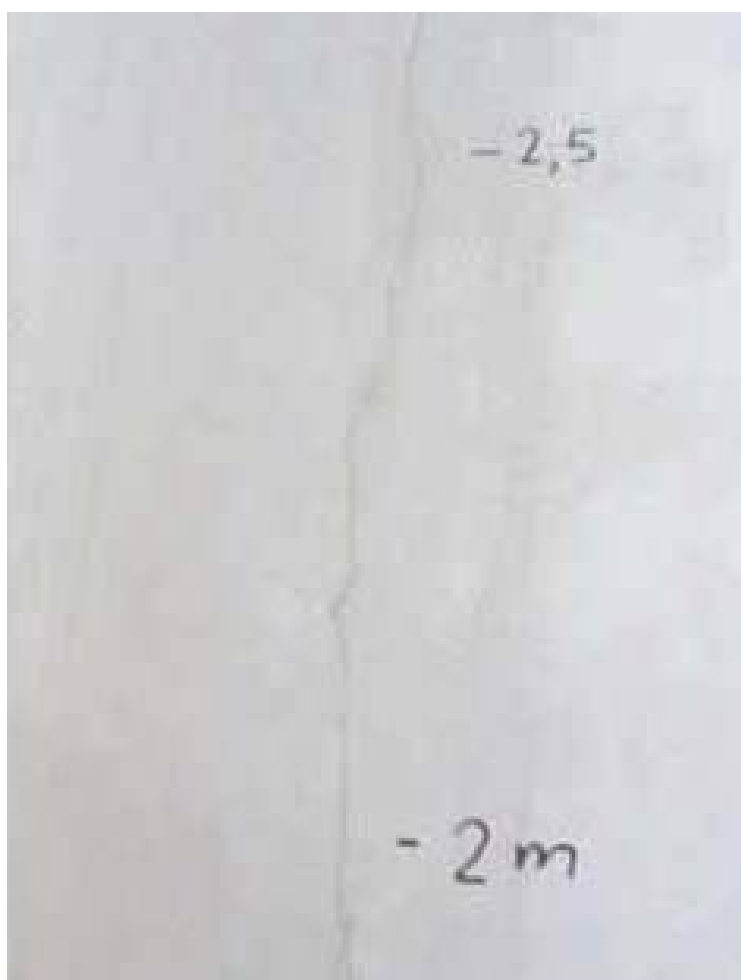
Pormenor de fissuração longitudinal no troço entre 2,0 e 2,5 m de cota
